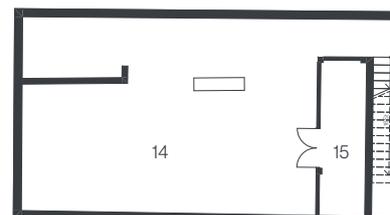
| Grundriss Erdgeschoß Bestand
